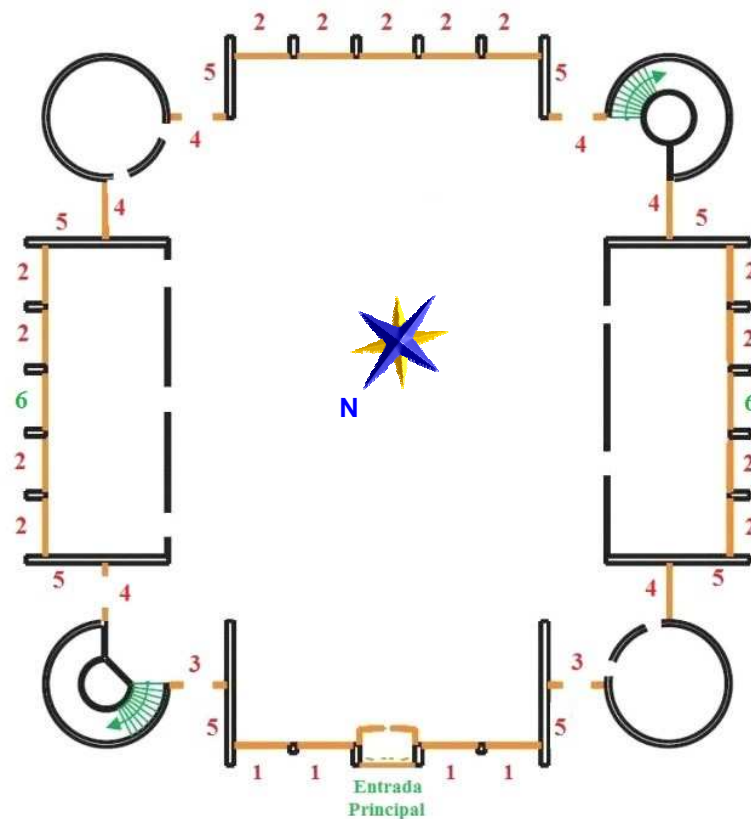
Esquema de planta baja (similar al de planta alta) con la ubicación de los componentes de las fachadas.
